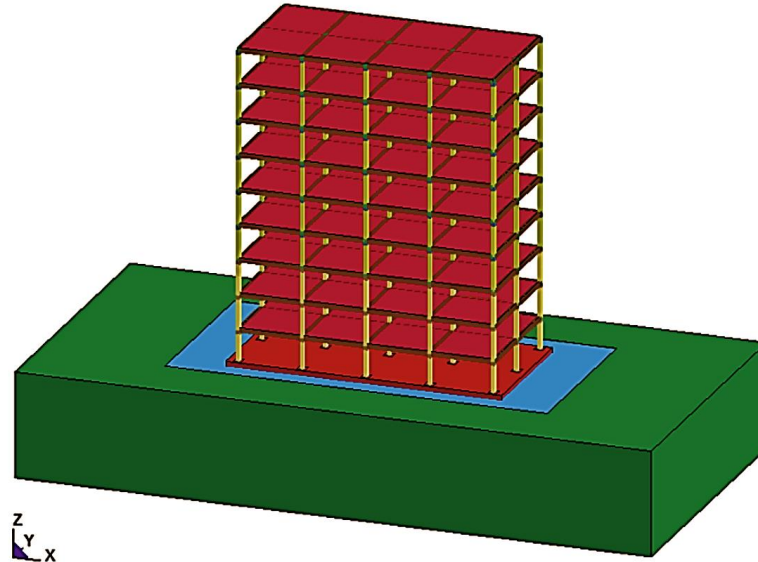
Расчетная схема 9-ти этажного железобетонного здания
